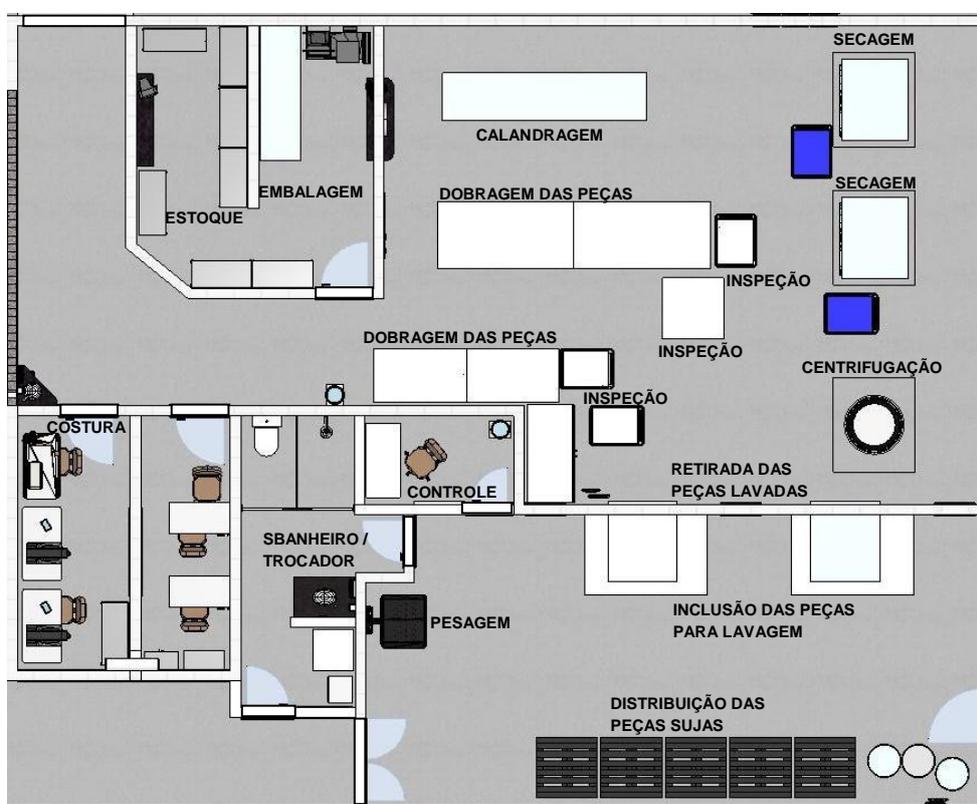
Planta baixa do layout atual dos setores da lavanderia.
